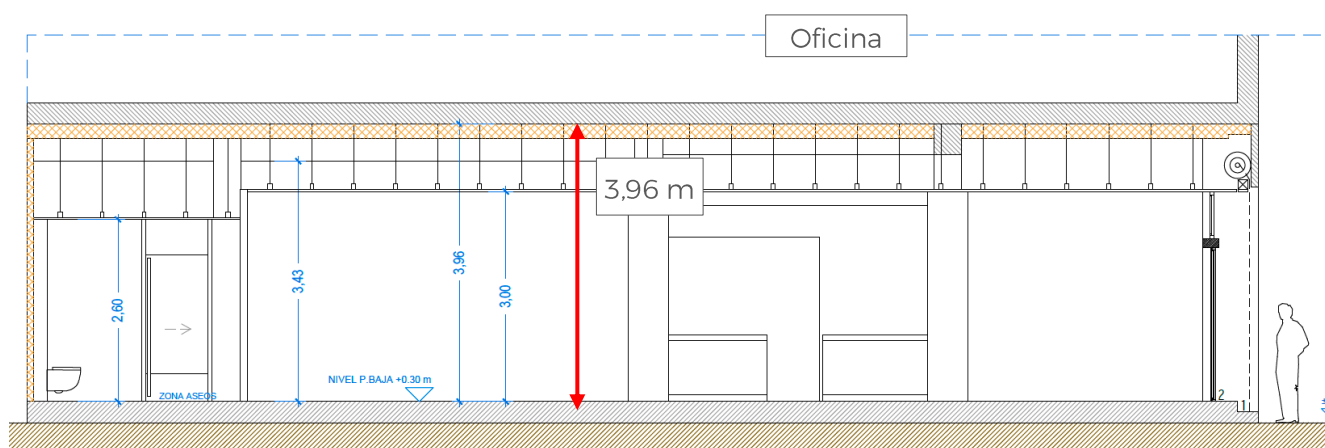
Sección longitudinal Local - Calle Belchite 2, Logroño.
